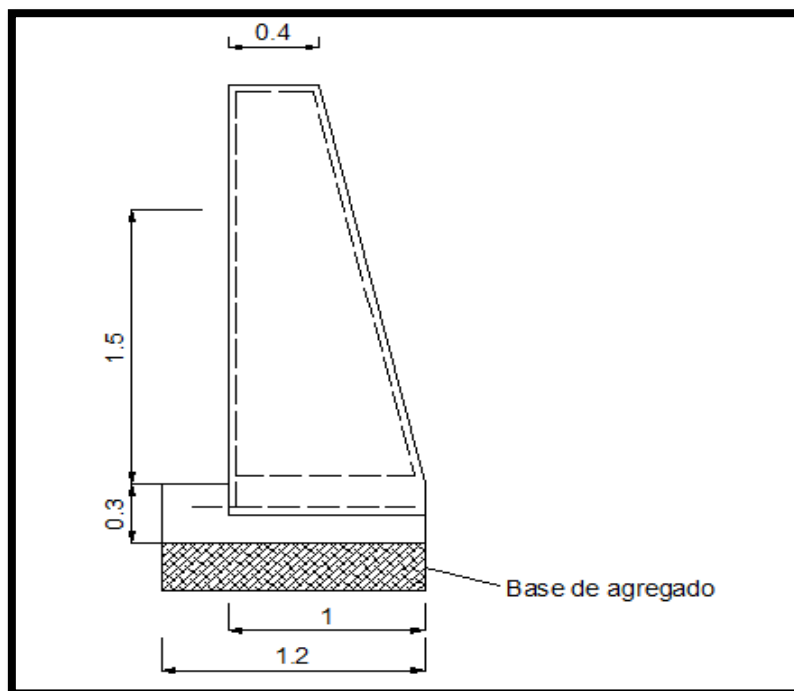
Elevación lateral de cabezal para alcantarillas de cajón.
